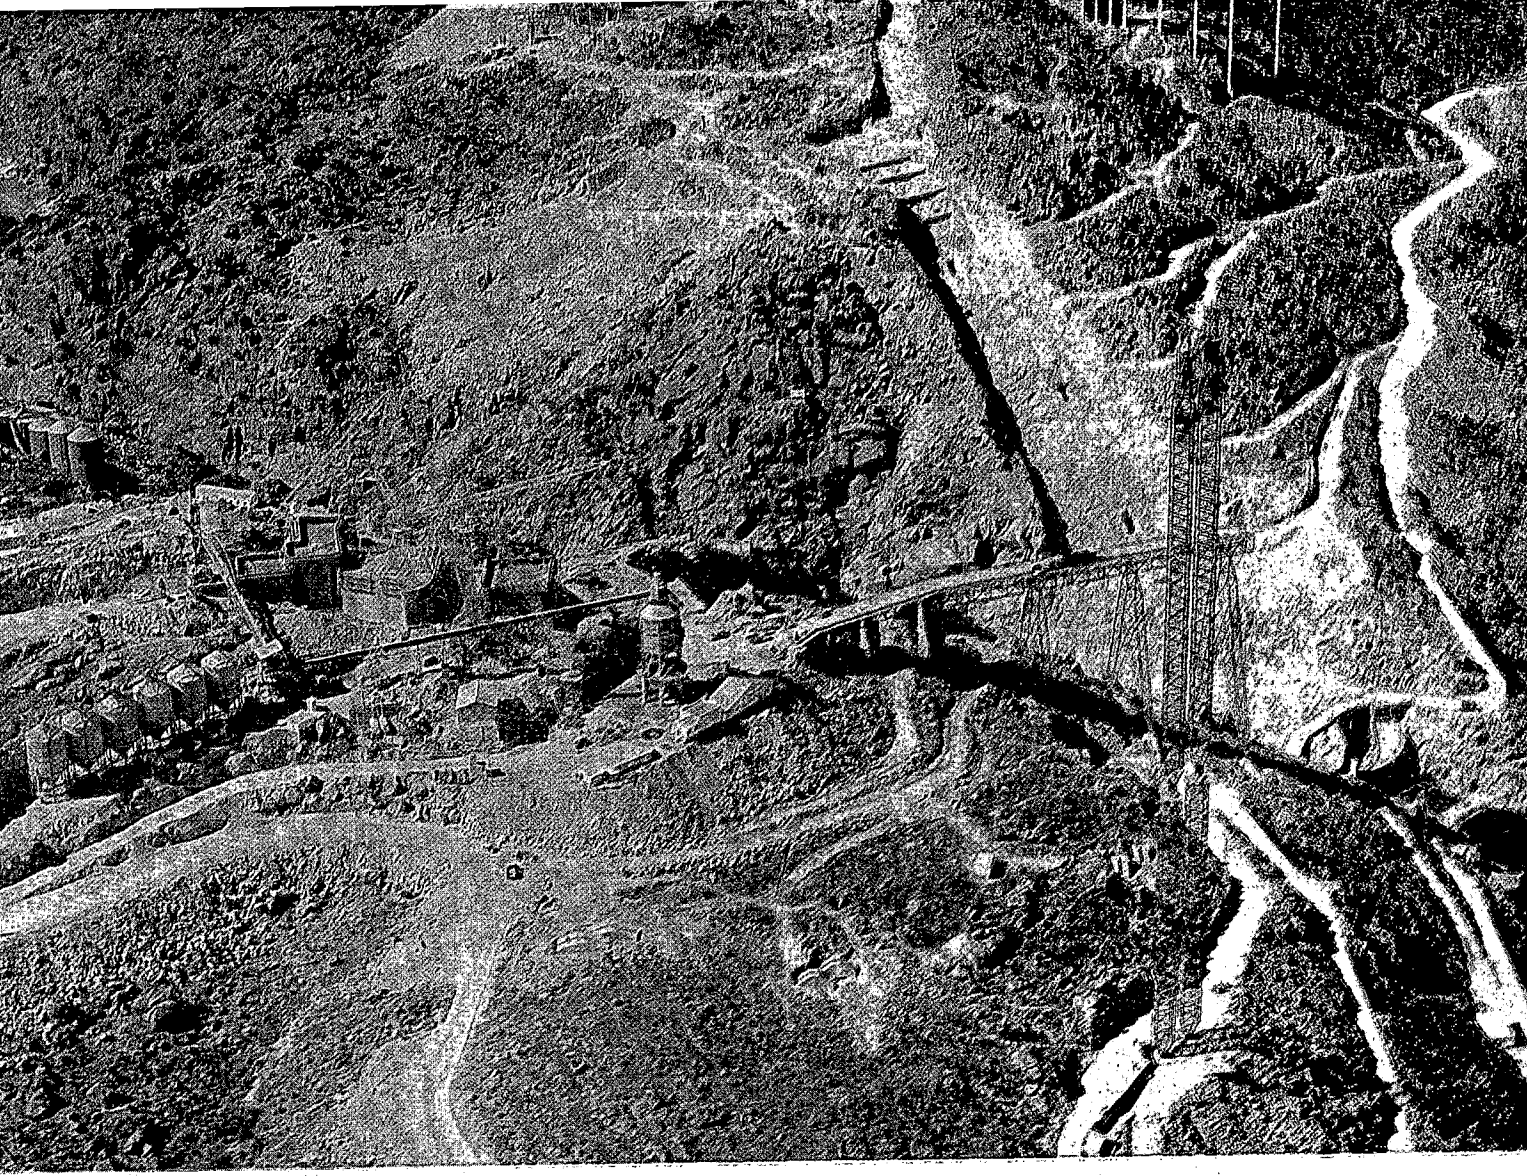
^a — Vista general de las instalaciones de puesta en obra del hormigón en la presa de Almendra, de IBERDUERO, S. A.
